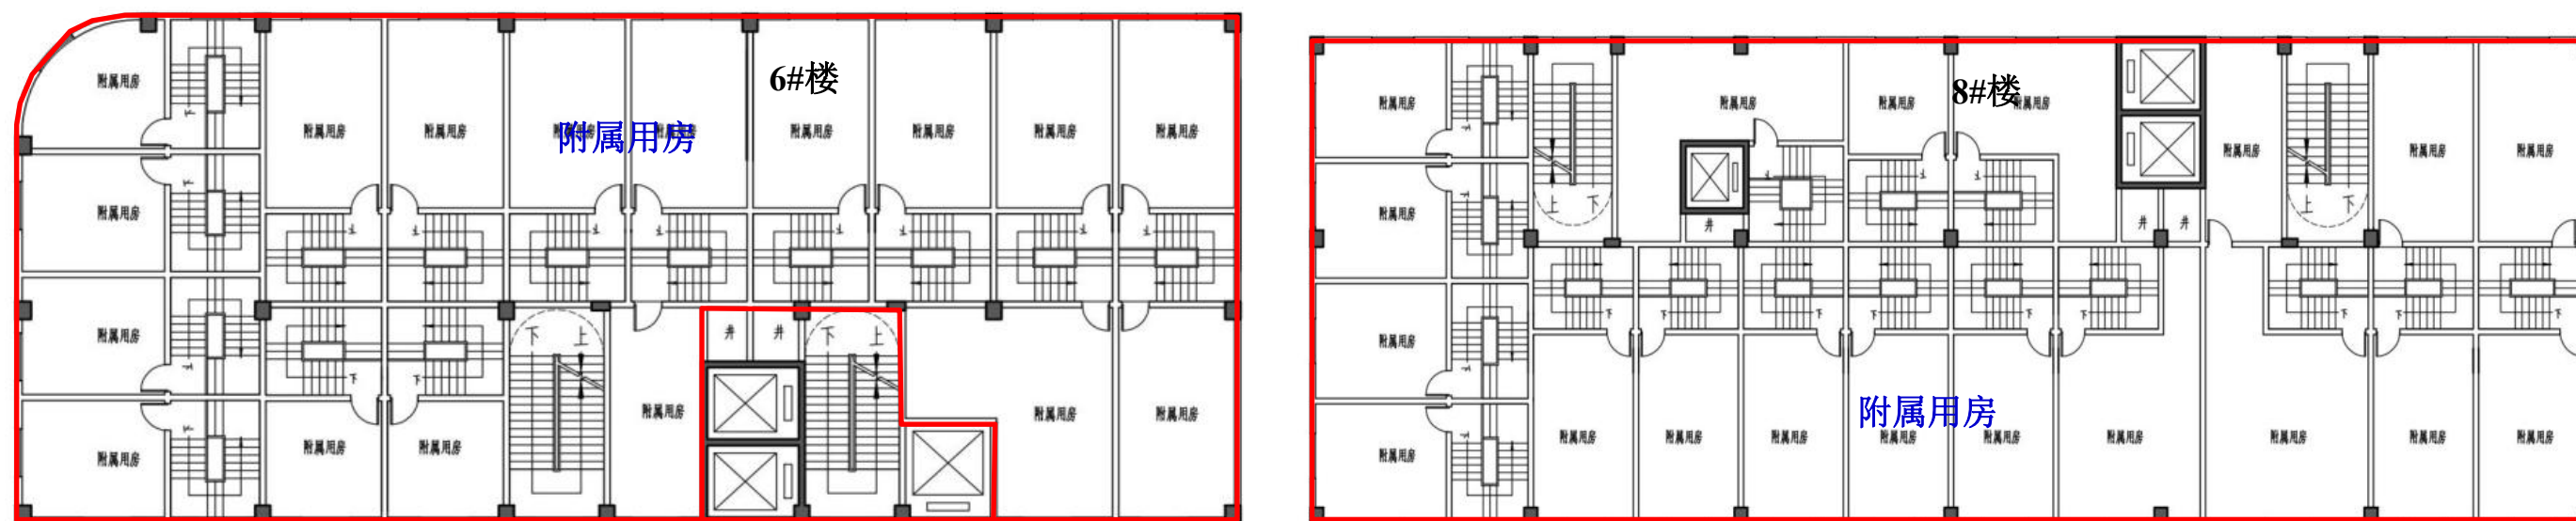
6#附属用房、8#自理楼二层平面图
